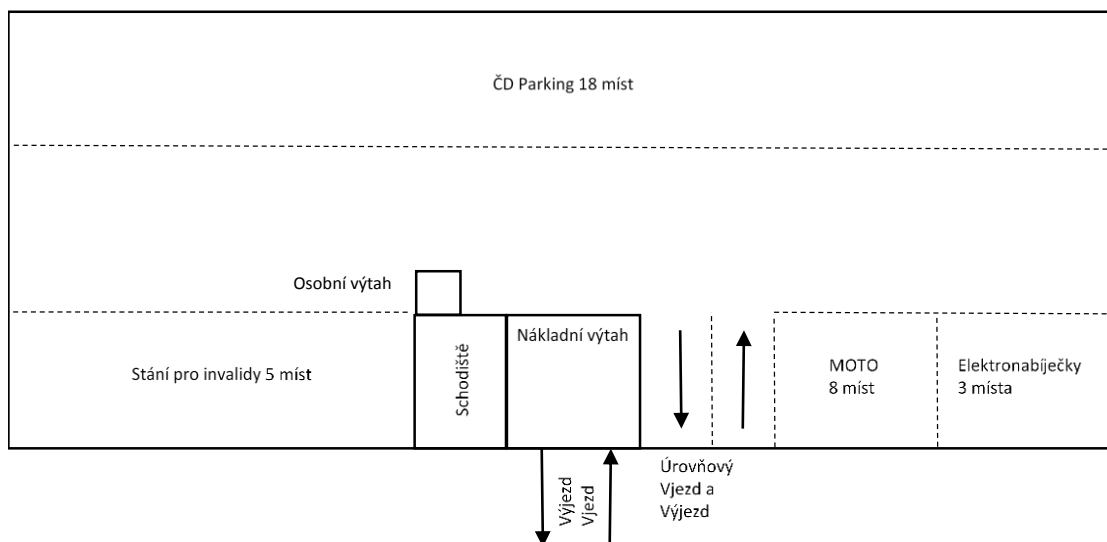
Schéma půdorysu podzemního podlaží parkovacího domu
